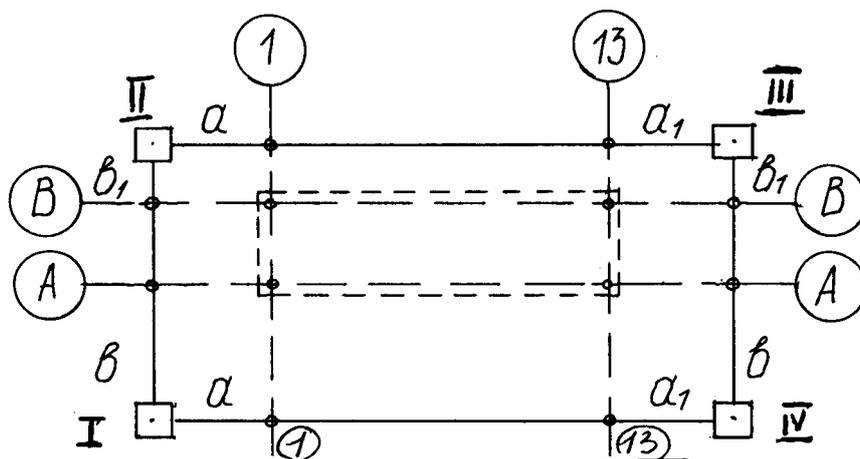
Схема перенесения в натуру осей здания от строительной сетки способом створной засечки
